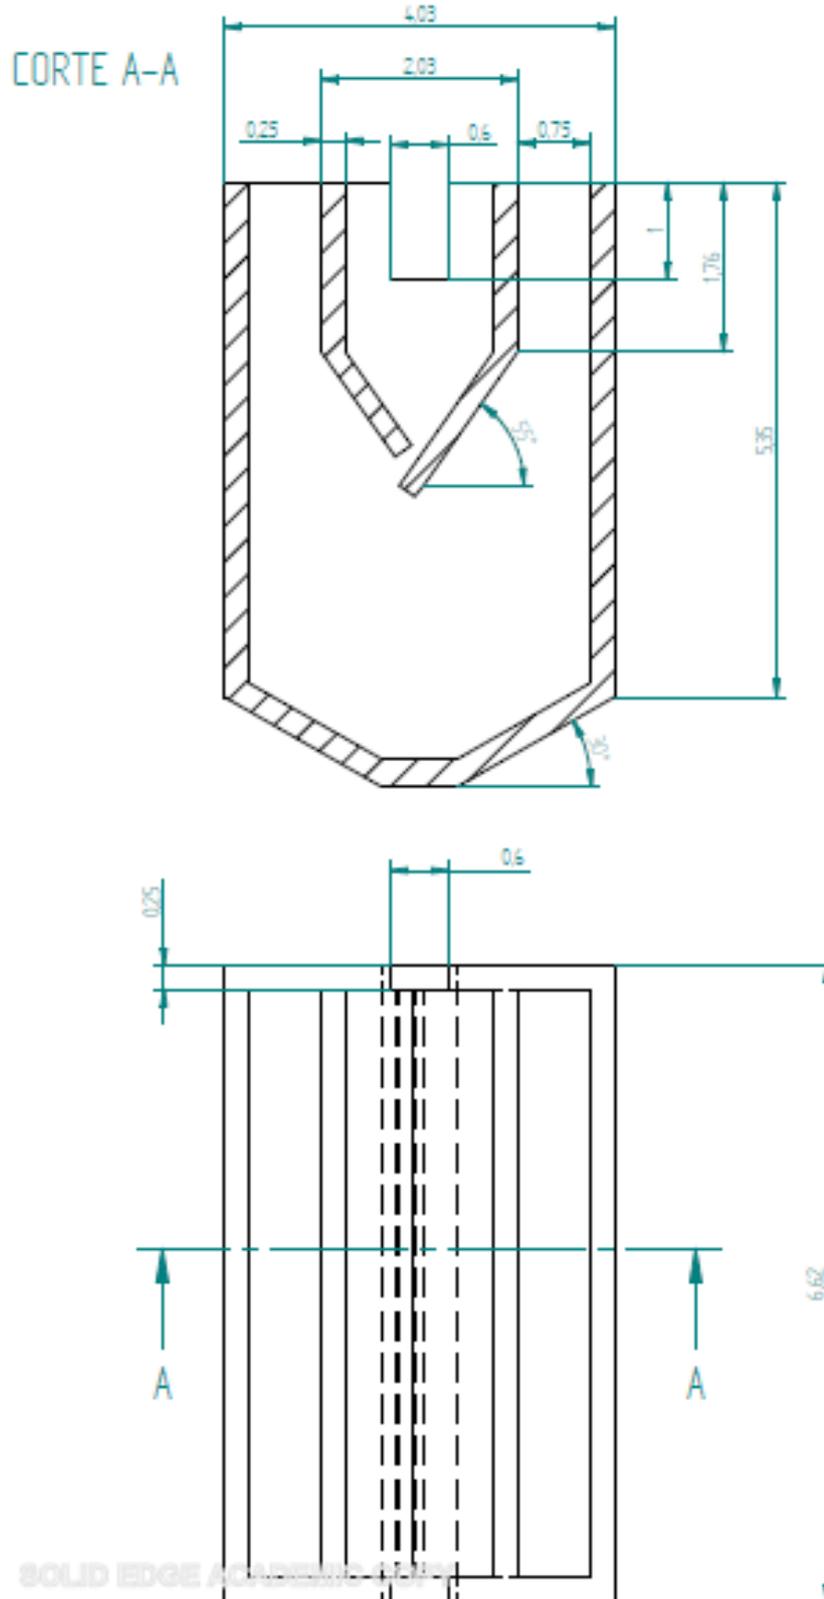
Plano constructivo tanque Imhoff (cotas en metros).
